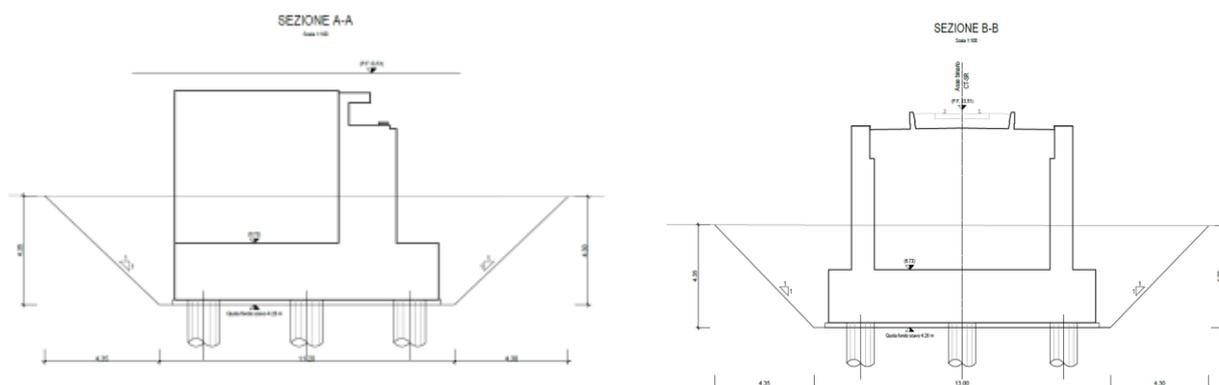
Sezione longitudinale spalla (sinistra) e Sezione trasversale della spalla (destra)
